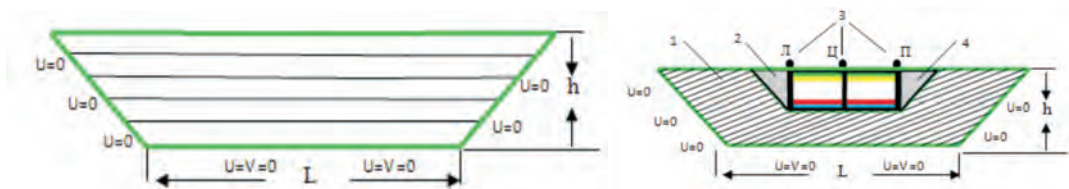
Расчетная схема к определению полей деформации горизонтально слоистого грунта до разработки котлована (левый рисунок) и расчетная схема задачи фундамент – наклоннослоистое грунтовое основание (правый рисунок)
